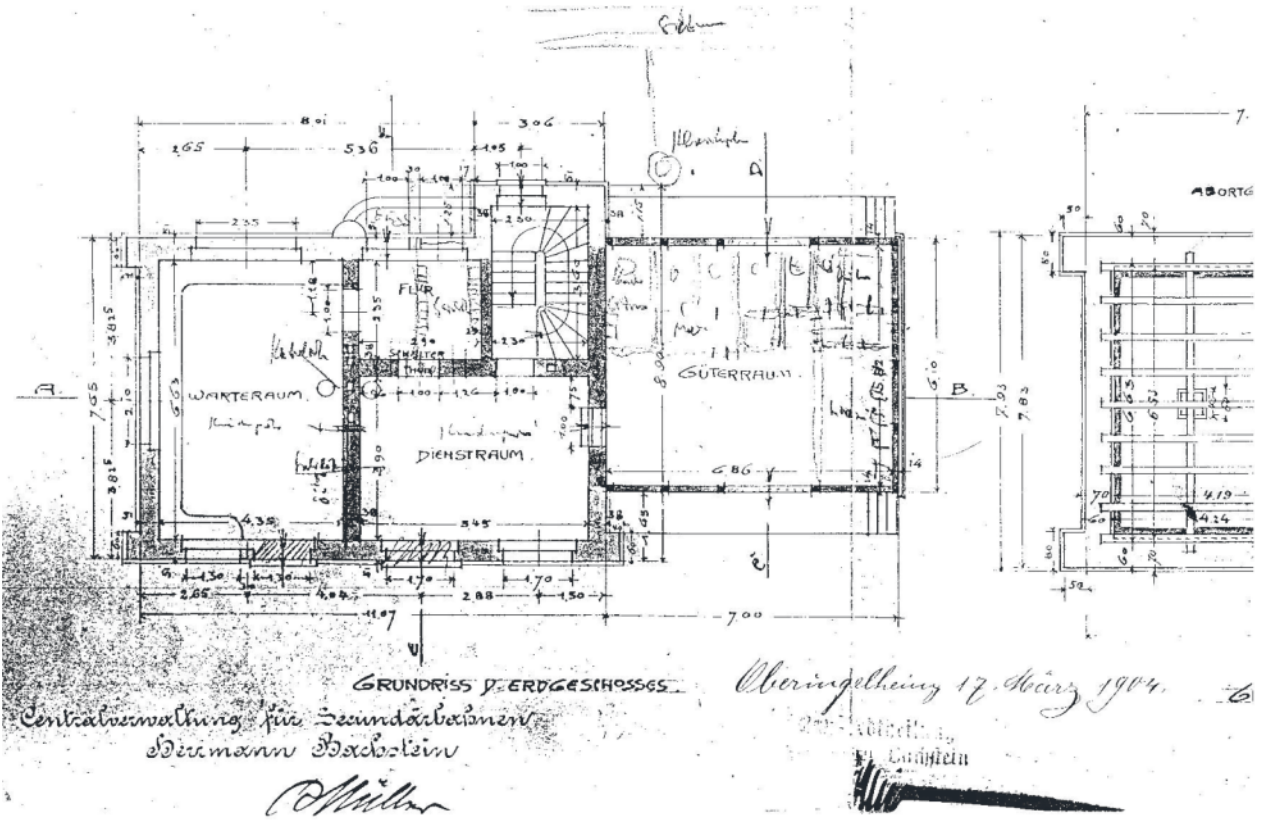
Der Bauplan mit Grundriss des Schwabenheimer Bahnhofs von 1904
